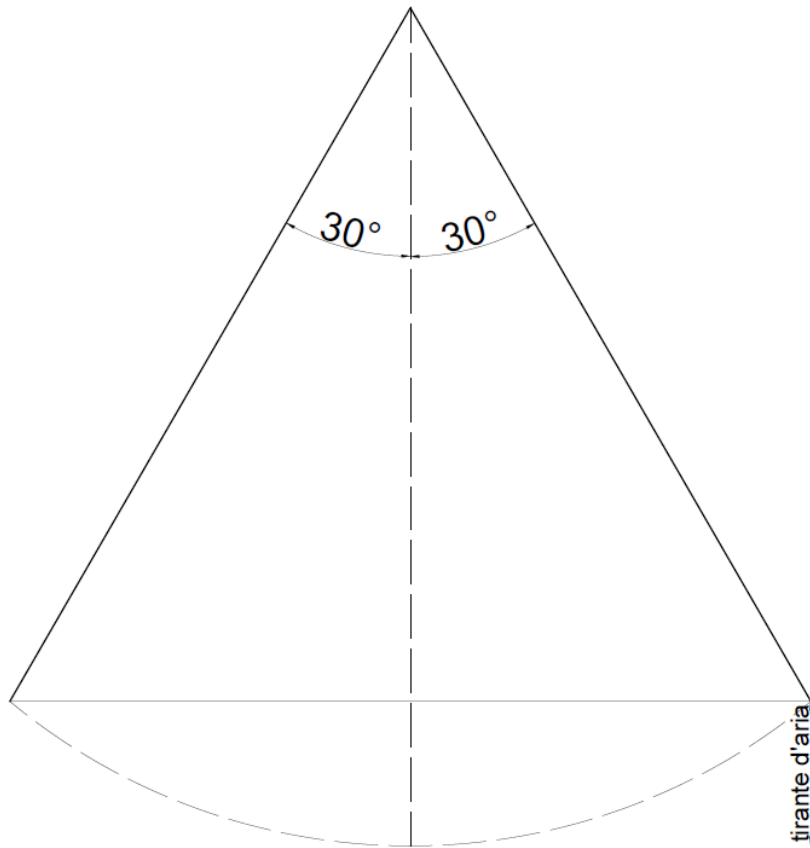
Effetto pendolo, campana a 60° -elaborata dall'autore
